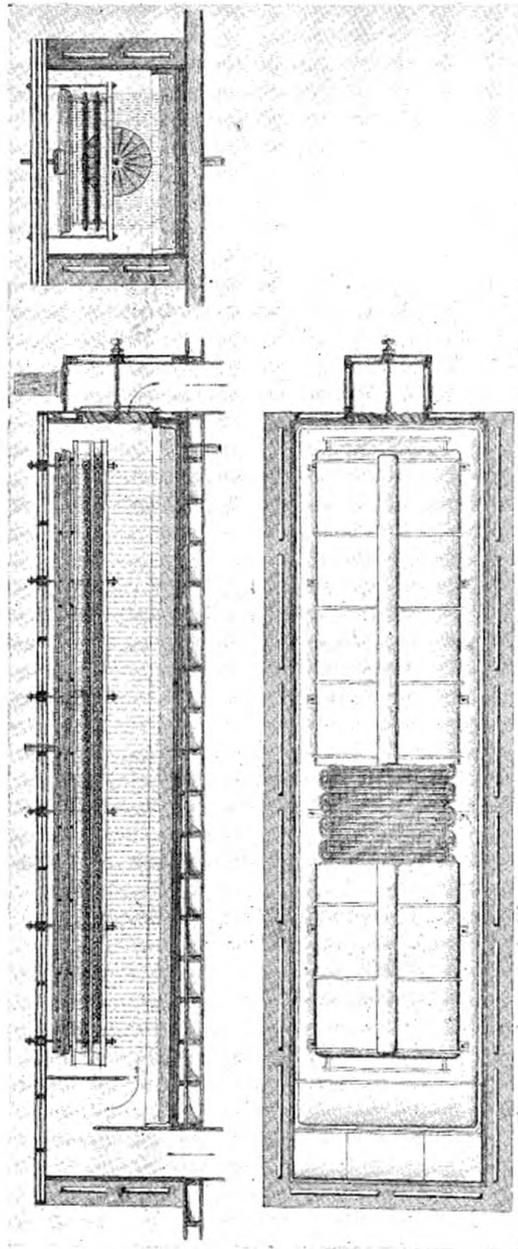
Refroidissement fait à ruissellement. Système B. Lebrun. (Coupe longitudinale)
